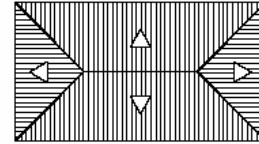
Planta de Cobertura de uma edificação com 4 águas
